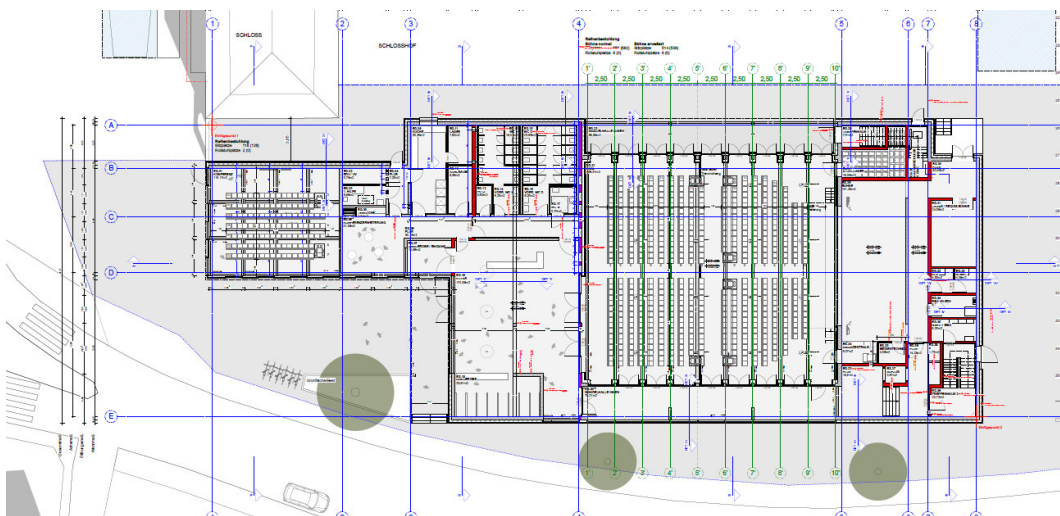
Grundriss der Festhalle; links der Konferenzbereich mit Übergang durch das Foyer zum Festsaal mit Bühnenbereich rechts
